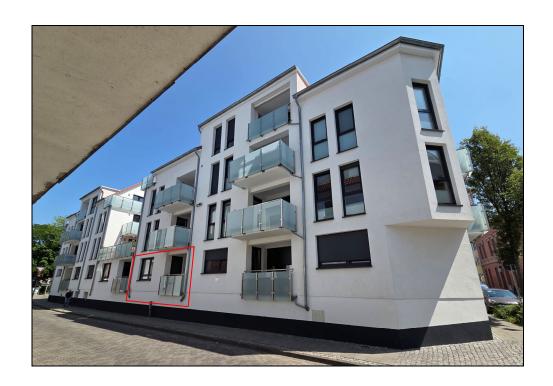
oben: Ansicht Ecke Wallstr. / Trompeterstr
